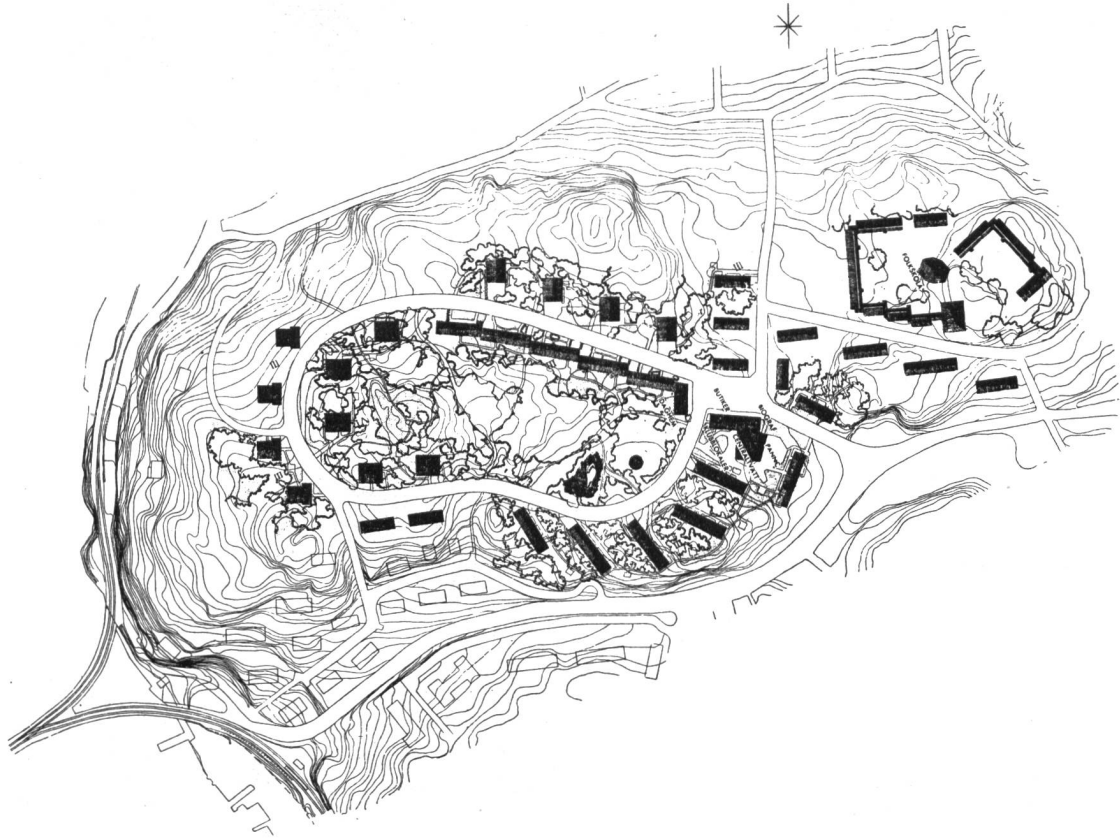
Punkt- und Schmalhausgruppe auf Lidingö bei Stockholm. Dreistöckige T-Häuser, achtstöckige Punkthäuser und dreistöckige Schmalhausgruppen bilden auf einer bewaldeten Kuppe eine lebendige Einheit.
